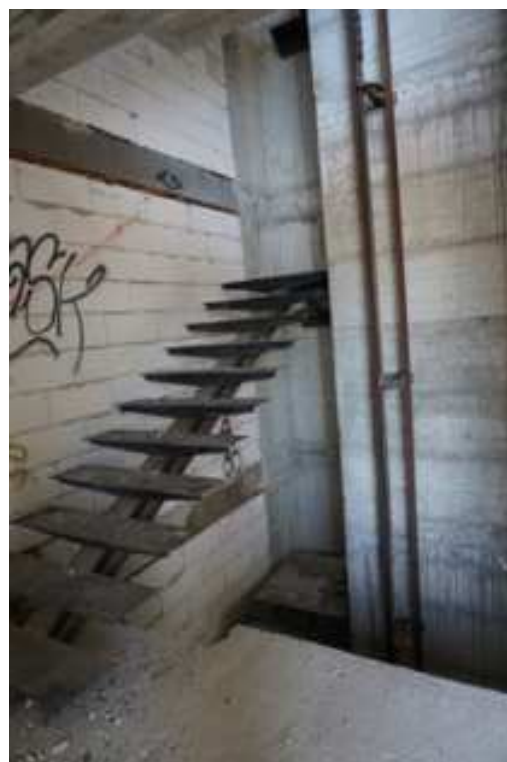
Vista su accesso al vano scala e rampa in ferro con trave (primo piano interrato).
